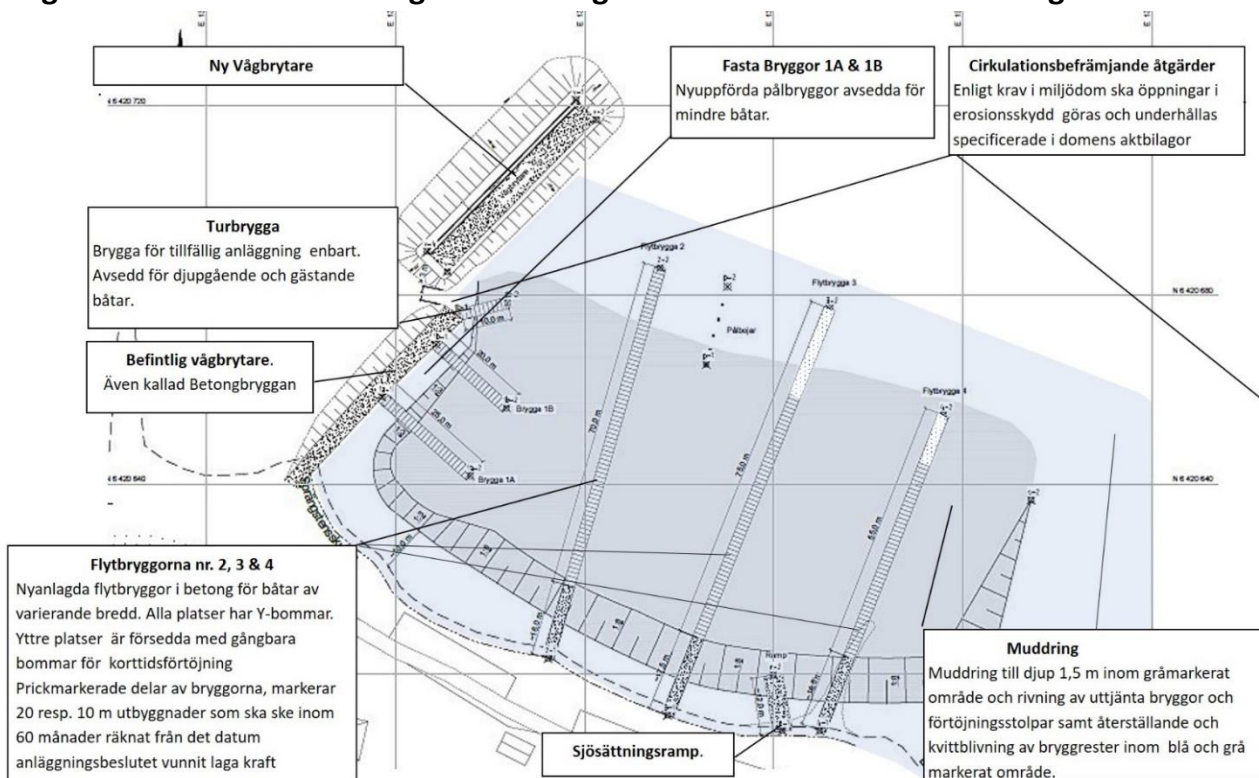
Upprustad hamn. Utformningen och placeringen av de fasta bryggorna närmast Betongbryggan kan variera över tid.
